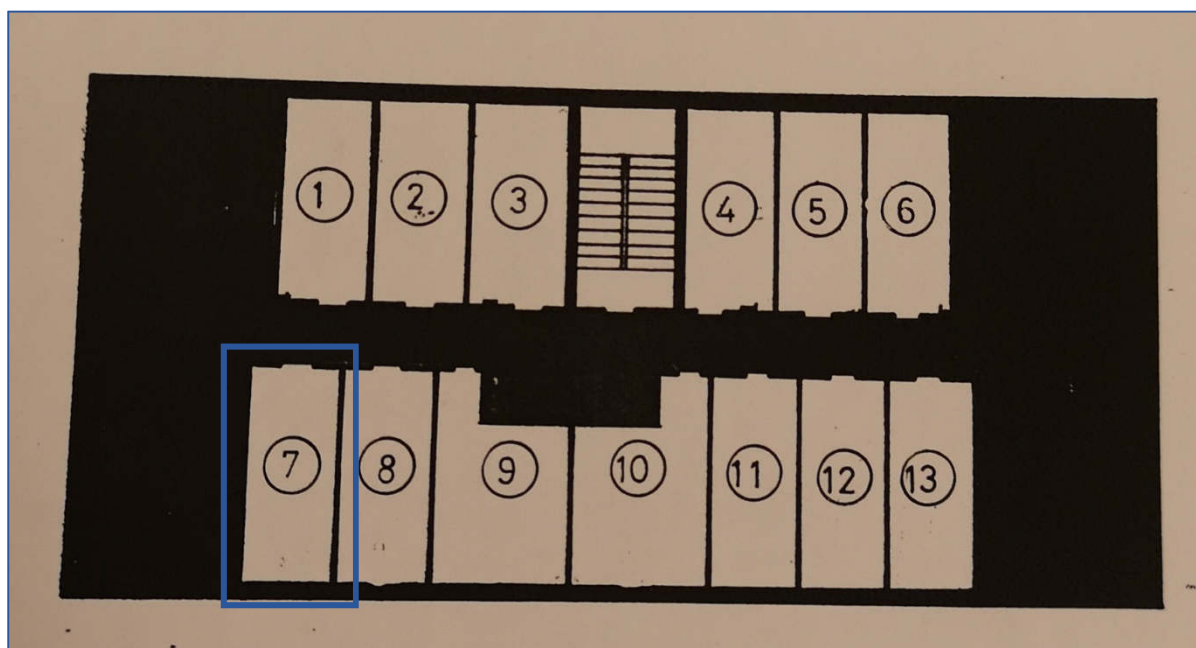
Estratto planimetria depositata con il Certificato di agibilità
